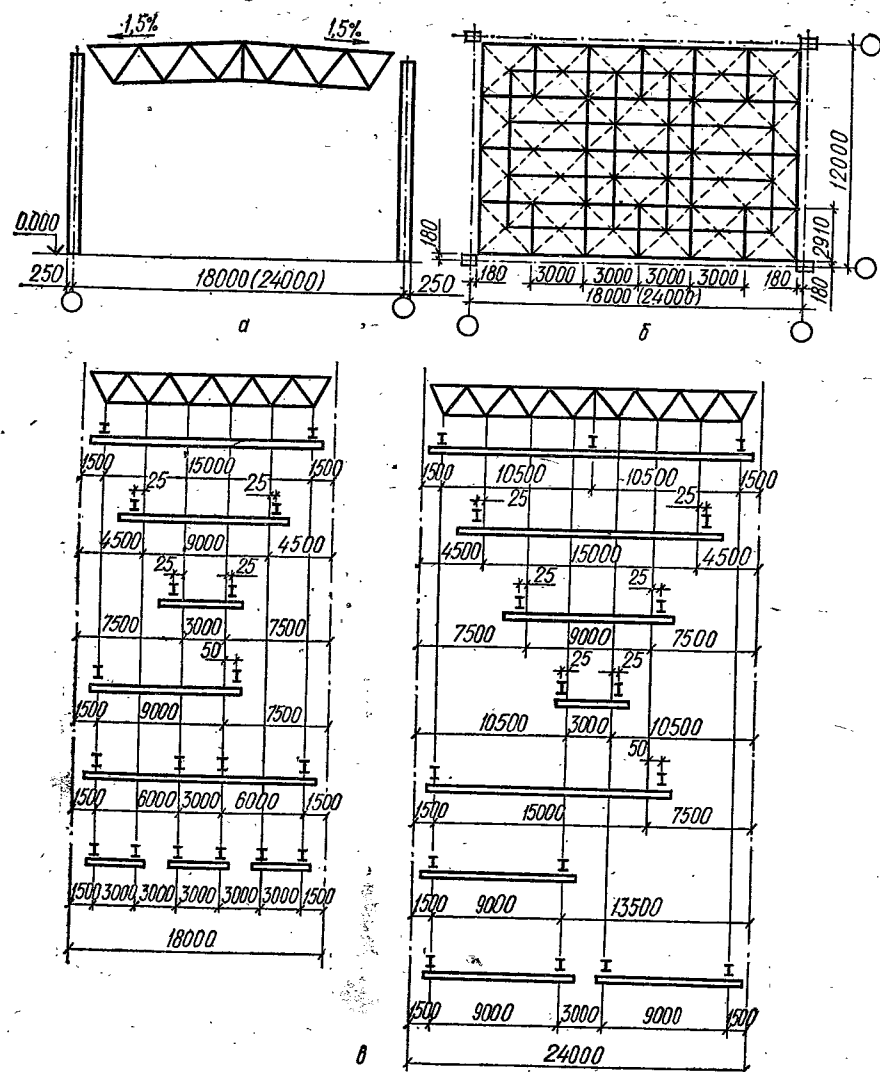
Секция каркаса с покрытием типа «ЦНИИСК»: а — поперечный разрез; б — план; в — схемы расположения подвешенного транспорта.
